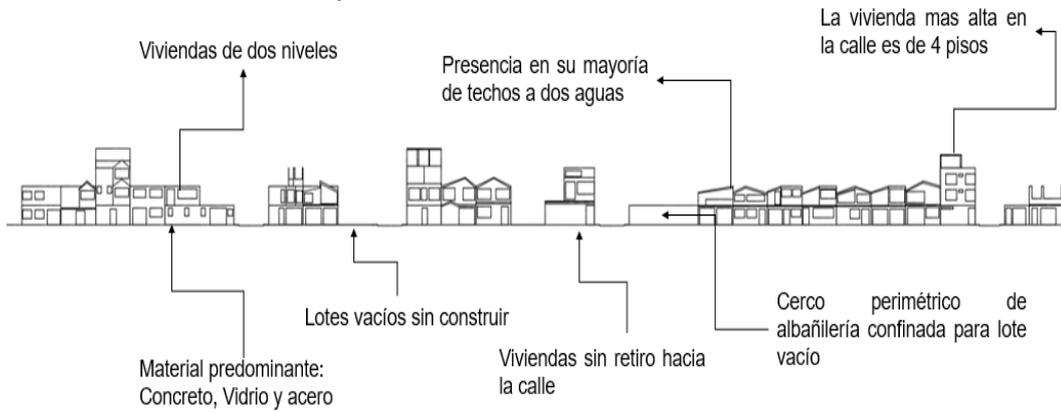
Edificación existente en el Perfil calle Las Vilcas
